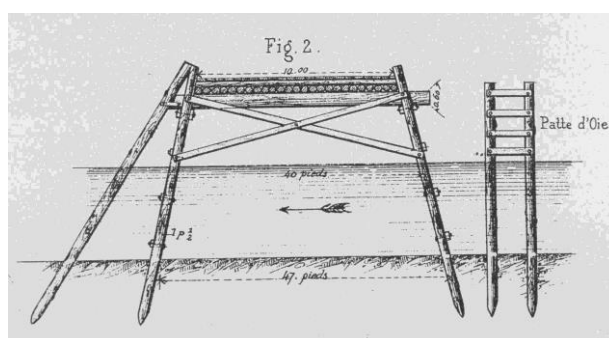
Fondations sur pieux du pont sur le Rhin (Reiffsteck, 2009)
